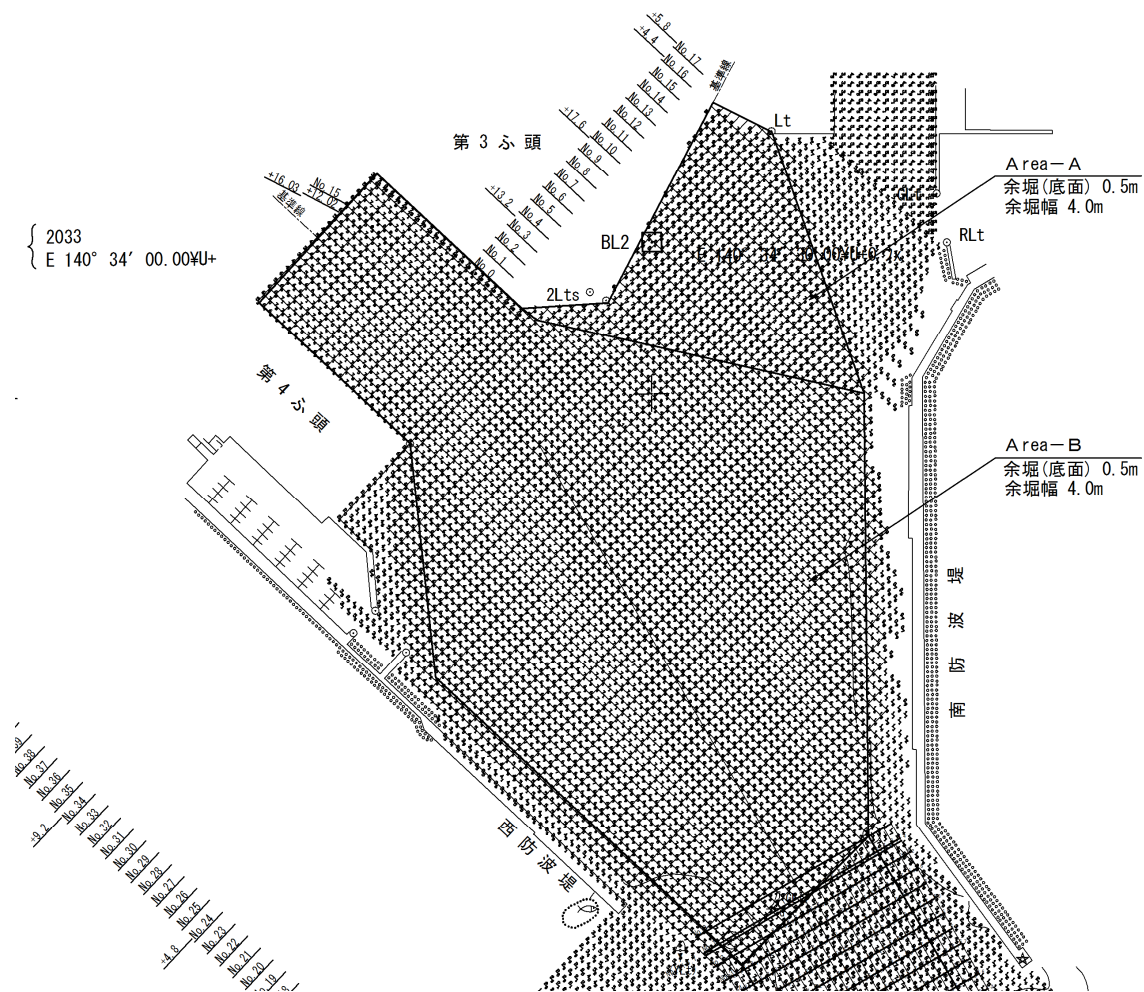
No.2 大洗港区\_中央地区泊地 (-8m) の平面図 (被災前)
